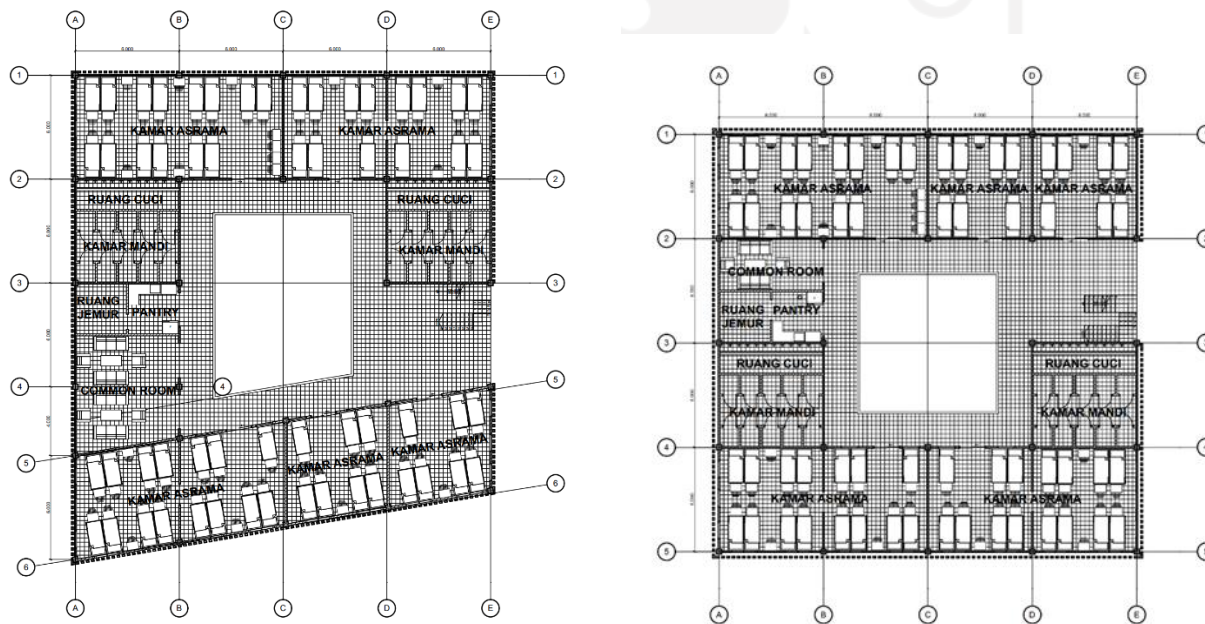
Denah Asrama Lantai 1 Sebelum Evaluasi
